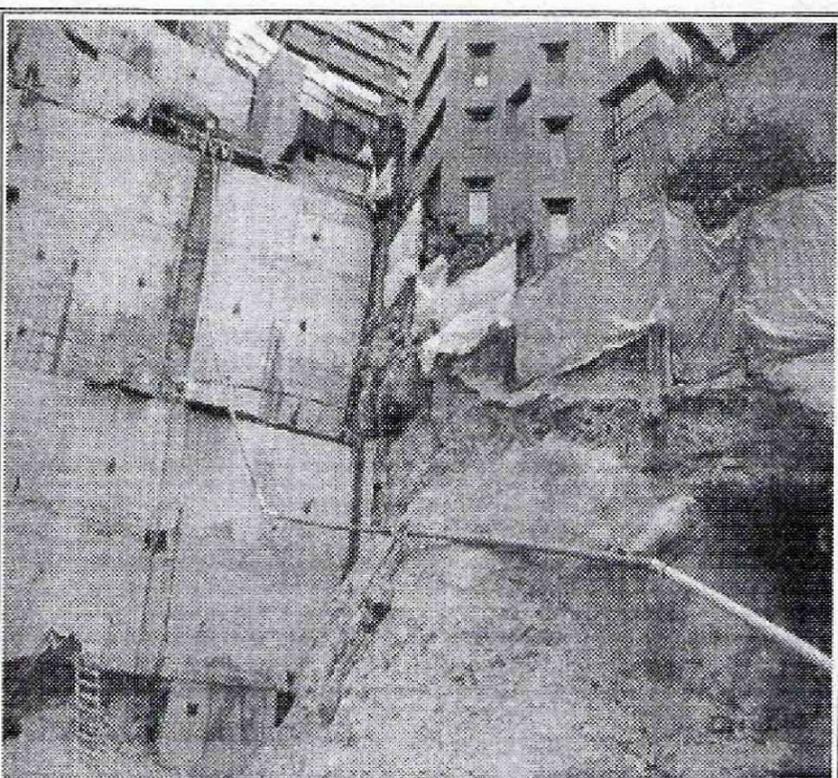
Vista muro contención sobre el costado norte Proyecto Radano Chico Alto
